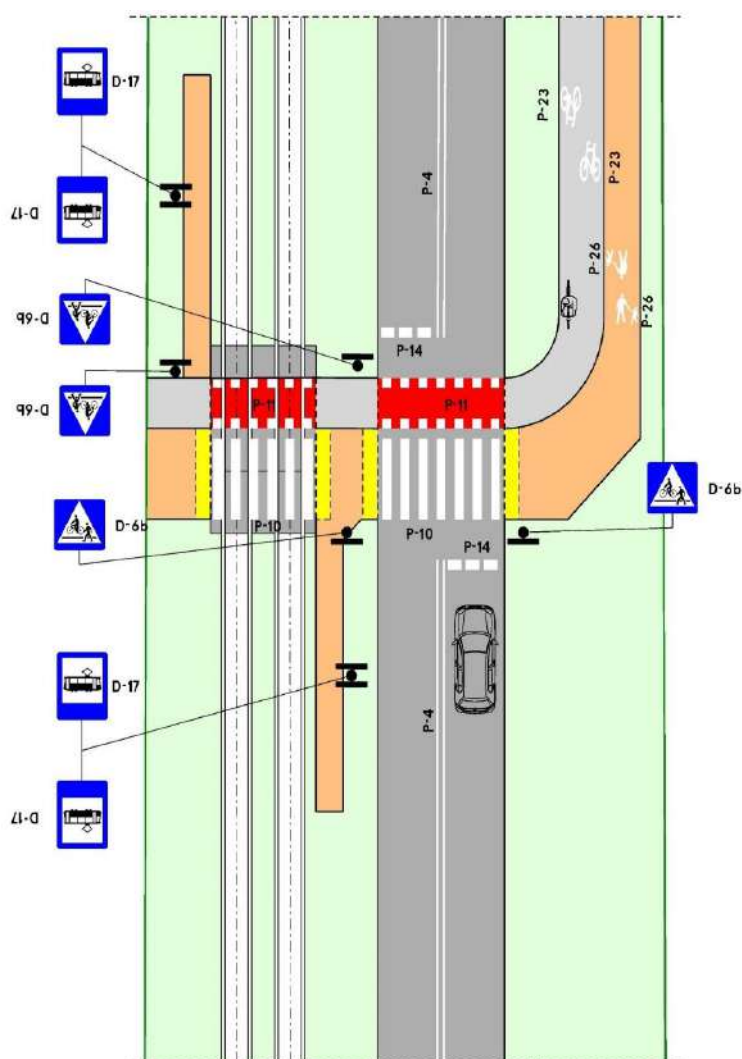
Przejazd dla rowerzystów na przejeździe kolejowym bez zapór.
